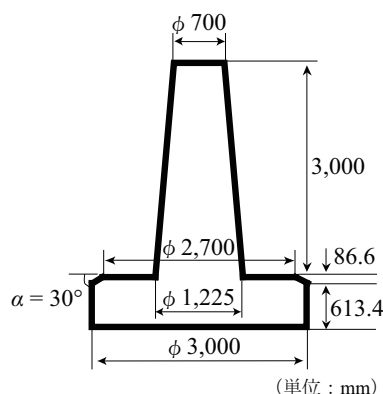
逆 T 型基礎の形状・寸法 (水平地盤の場合)
